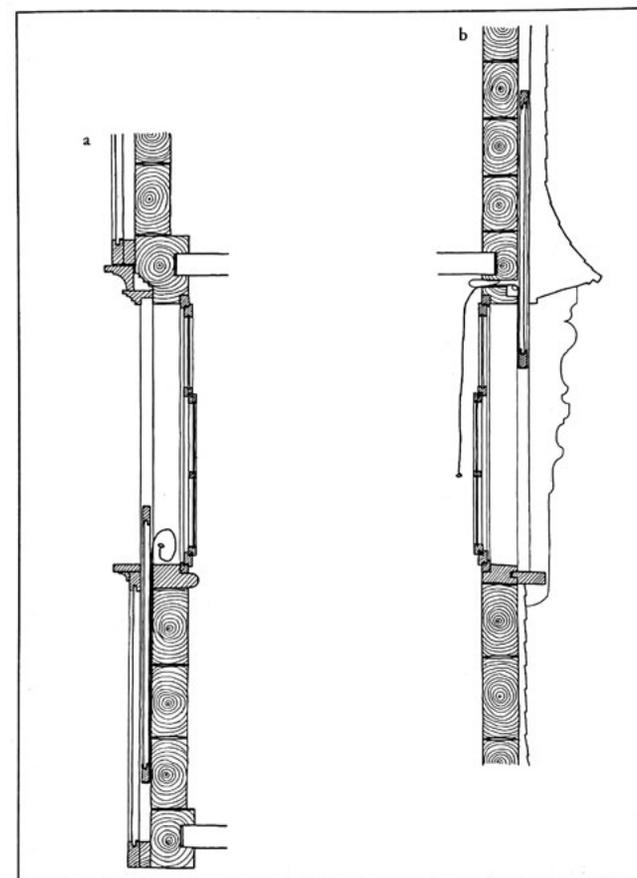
Schliessvorrichtung mit Ladenriemen a) Aufzugsladen b) Fallladen
